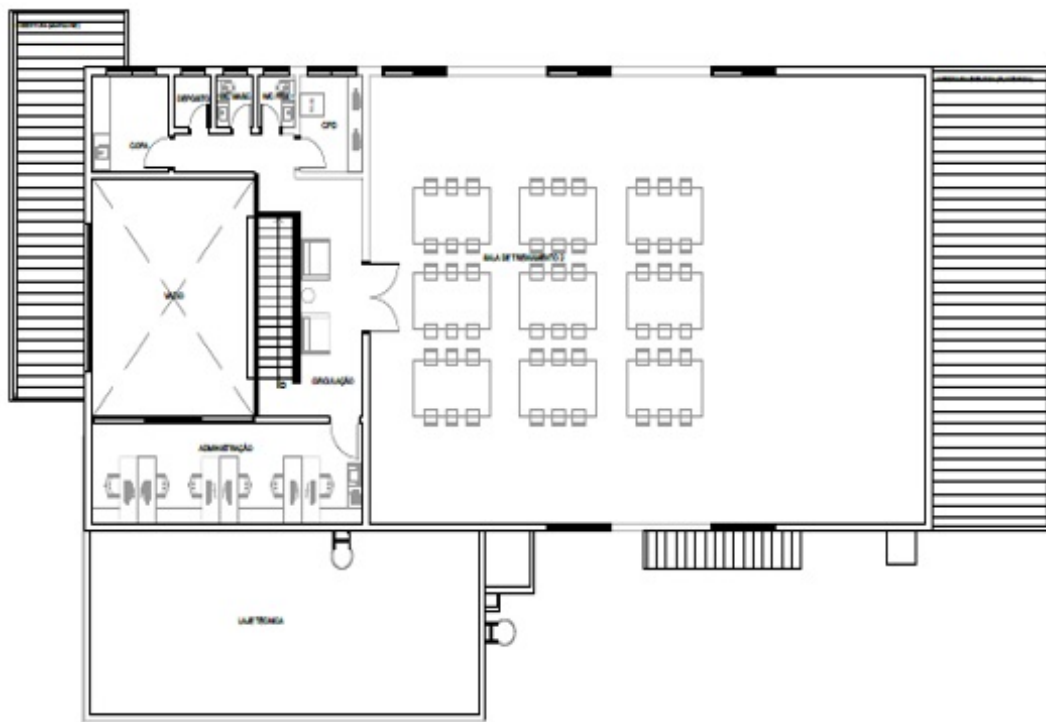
Planta Baixa Andar Superior Centro de Treinamento - Fonte: (AUTOR)
